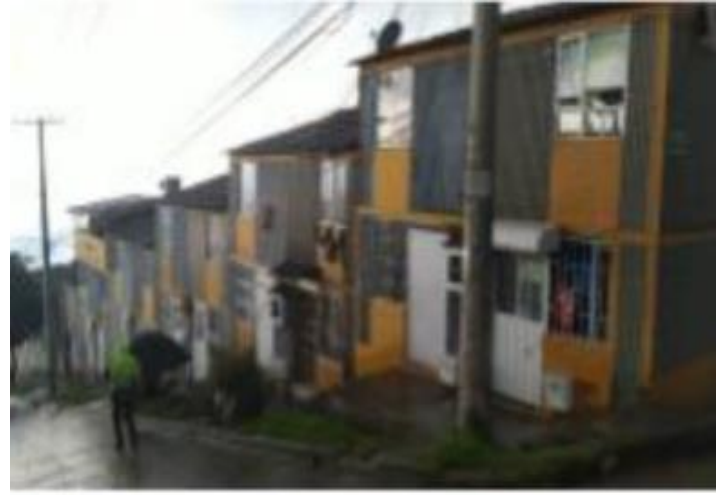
CARRERA 16 A ESTE CON CALLE 41 A SUR (ZONA DE APARTAMENTOS) BUEN ESTADO
